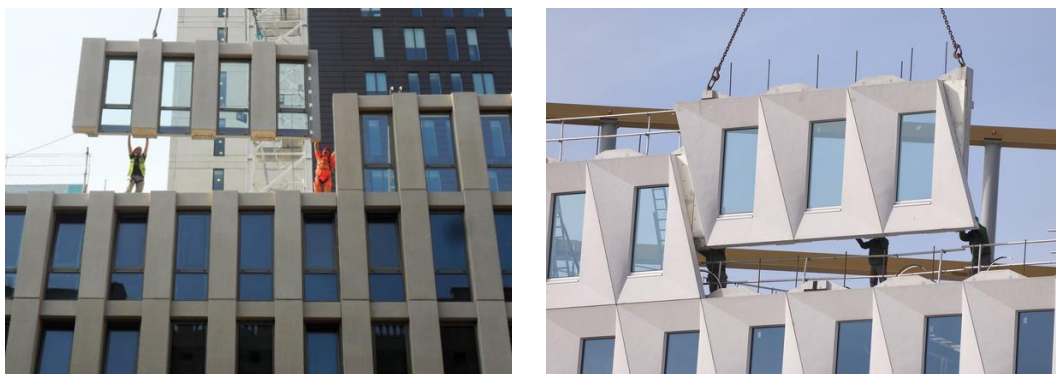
e 46 (i): Exemplo de Sistema Construtivos de Elementos Modulares.
